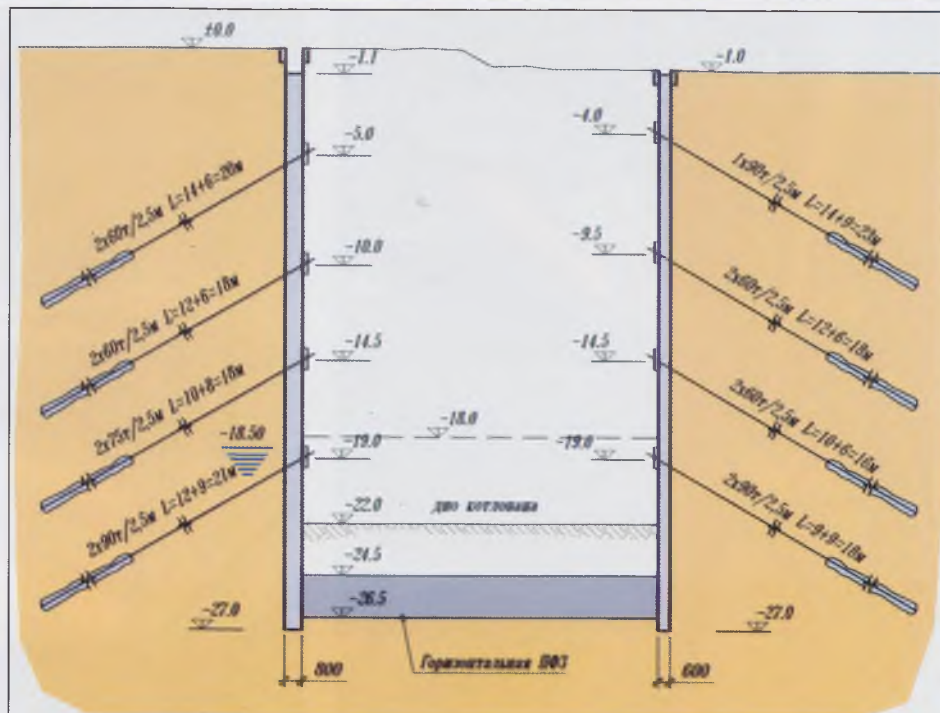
Строительство подземной автостоянки на Via Puccini в Милане. Принципиальное решение горизонтальной противofильтрационной завесы из секущихся грунтоцементных колонн
